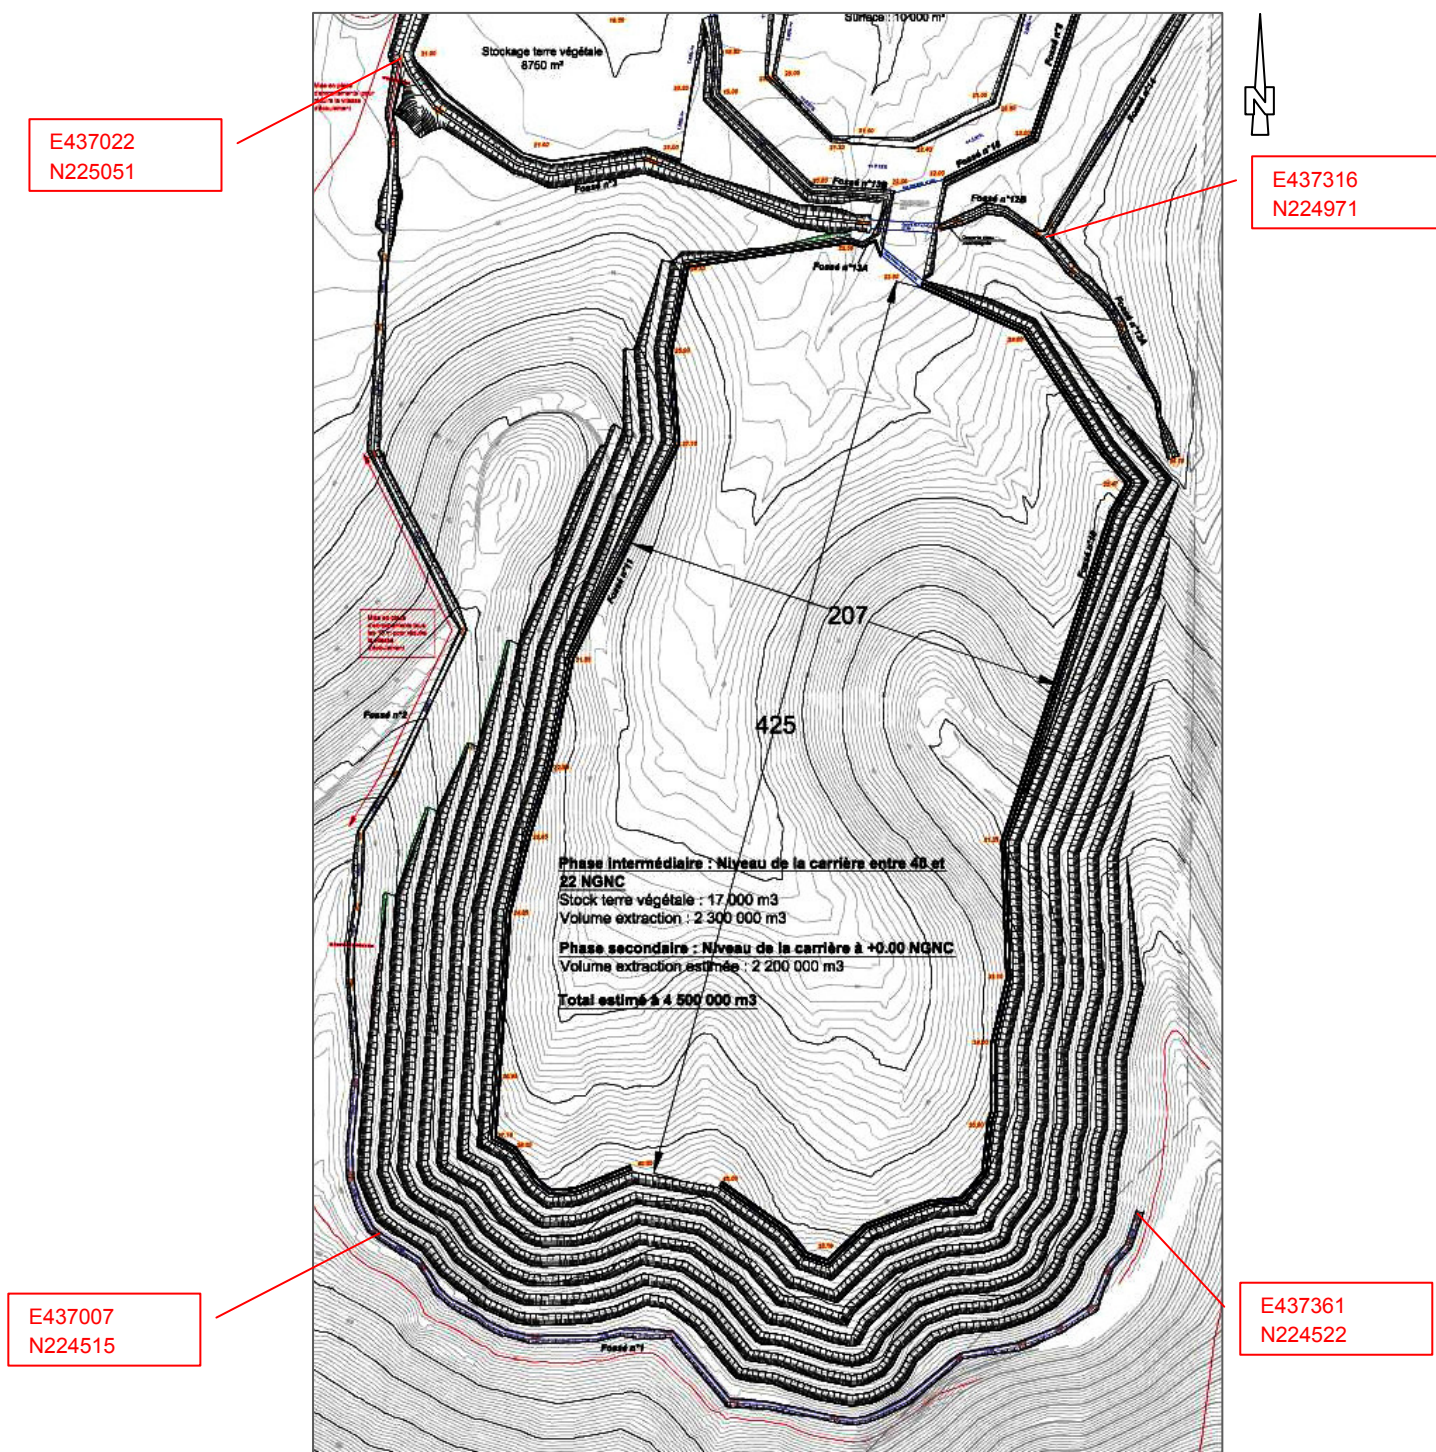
Extrait plan VRD01 Plan de terrassement - Projet de carrière (Données GINGER SOPRONER)
